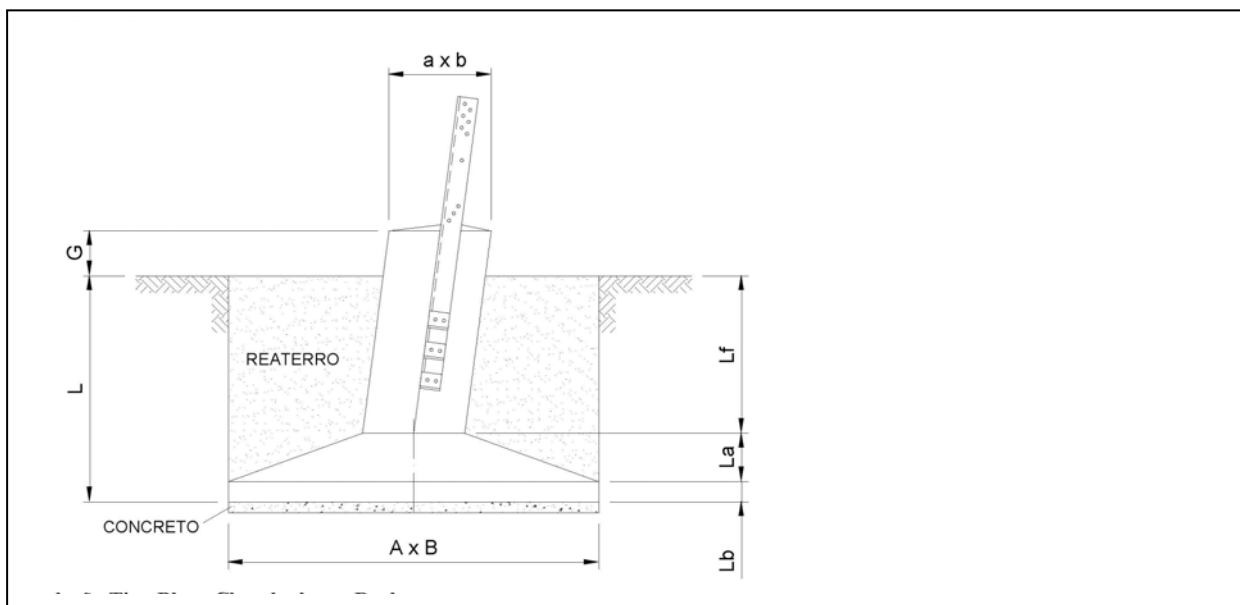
Fundação Tipo Sapata.
